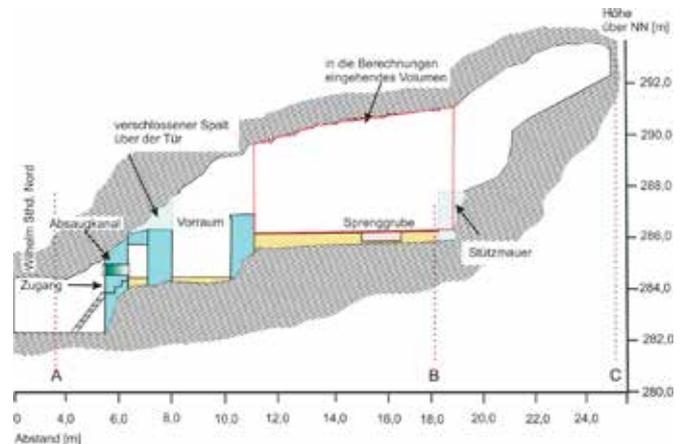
Schematischer Grundriss des SWL (2011).
